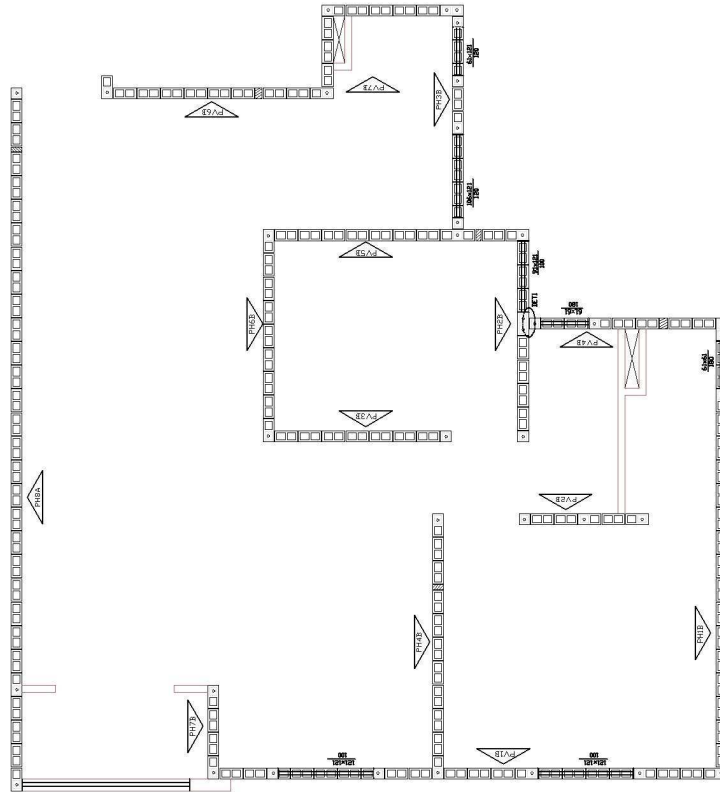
Planta de execução de apartamento em Águas Claras – DF
